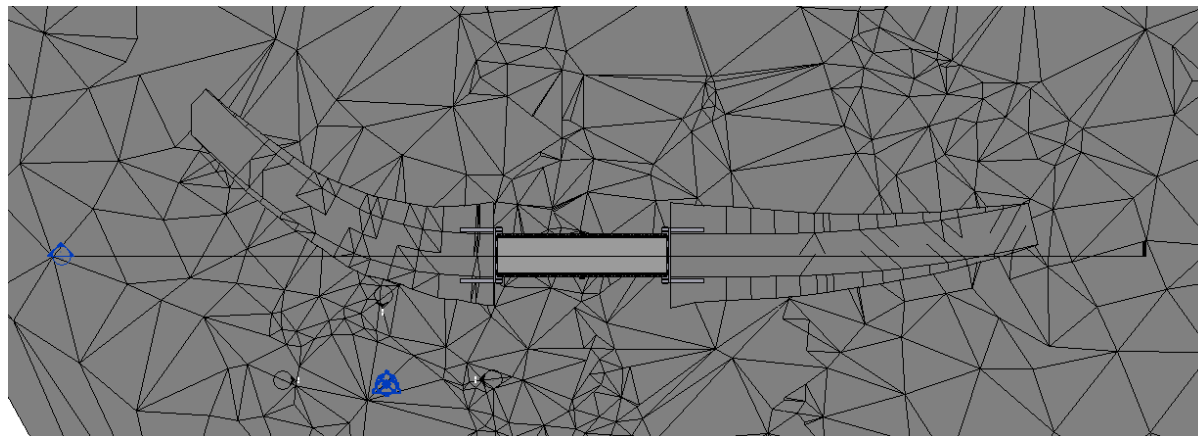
Vistan en planta del modelo con sección con archivo .ifc. Elaboración propia con Revit.
